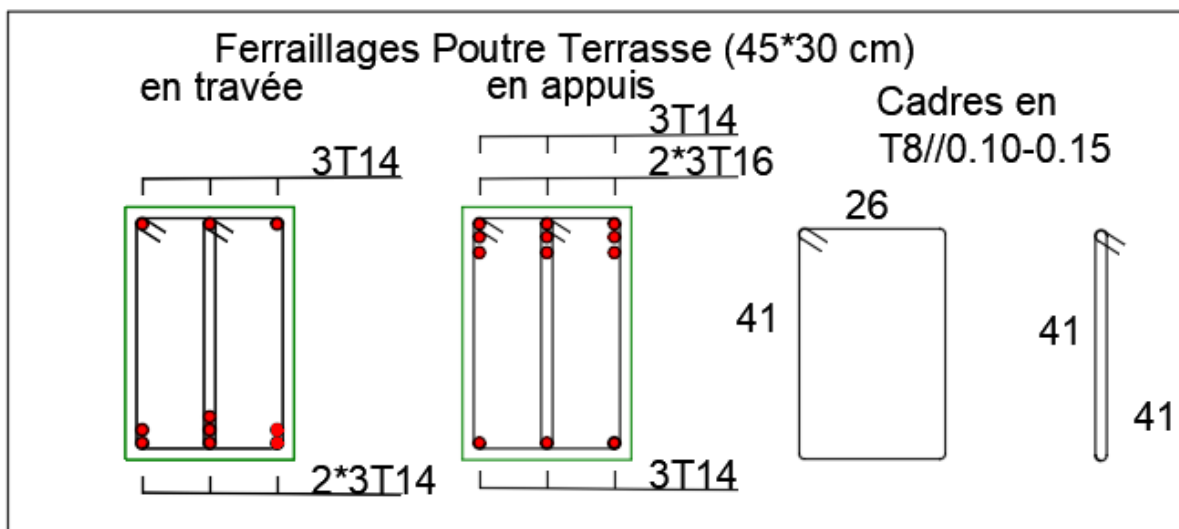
Ferrailages Poutre Noyée Terrasse 45\*30 cm.
